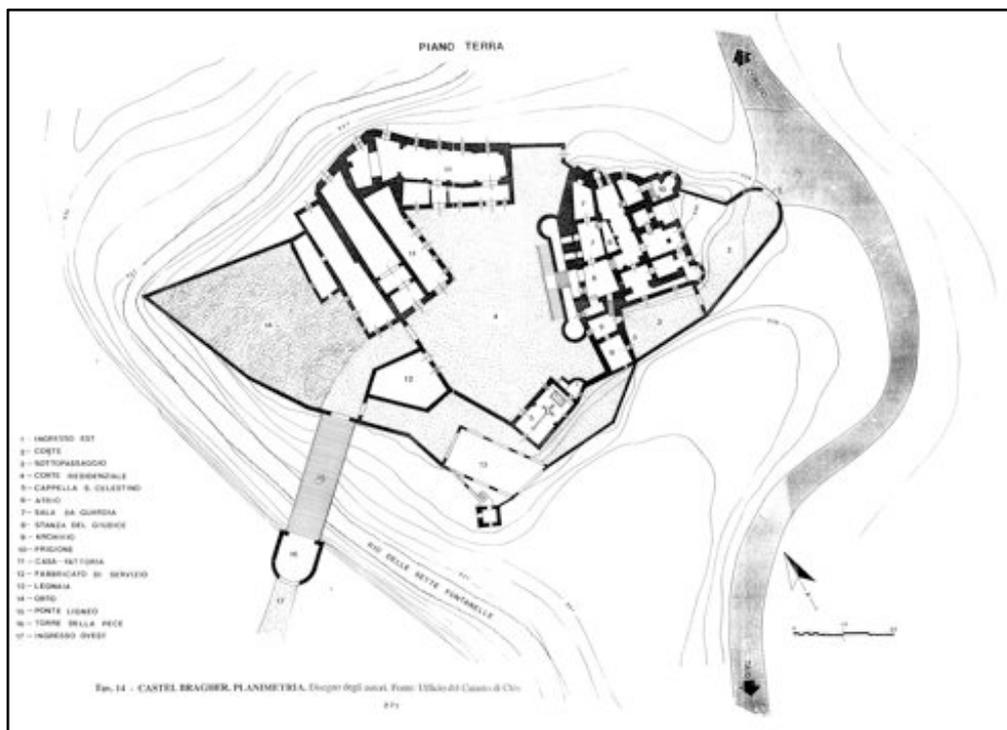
b – Planimetria di castel Bragher Bertò, Clauser 1995-1996; attuale ingresso al castello.
